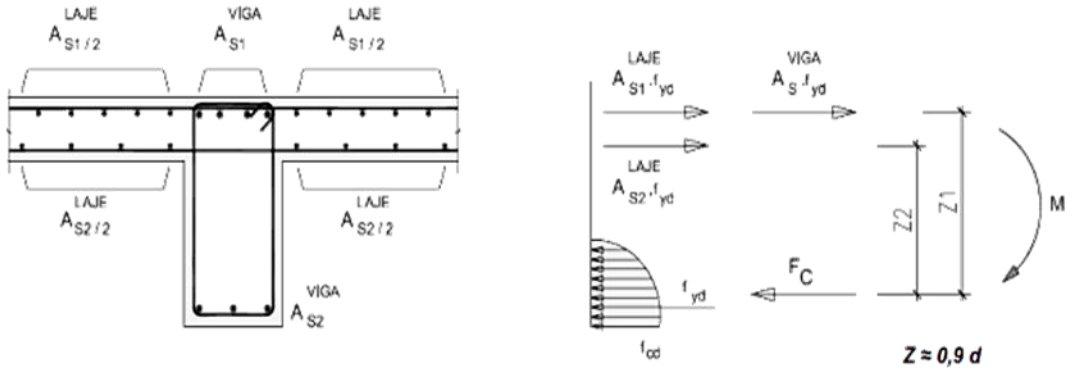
Contribuição das armaduras e da viga e da laje para o momento resistente real da viga sísmica (Costa, 2011)
